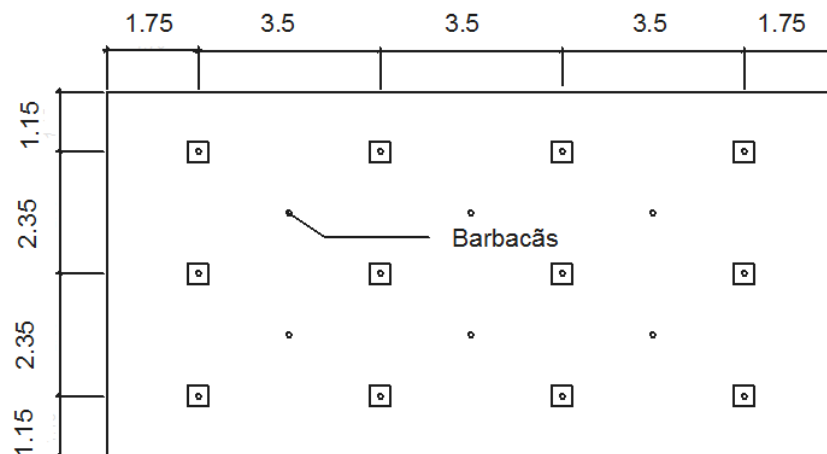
Planta baixa com sistema de drenagem do tipo barbacãs.
